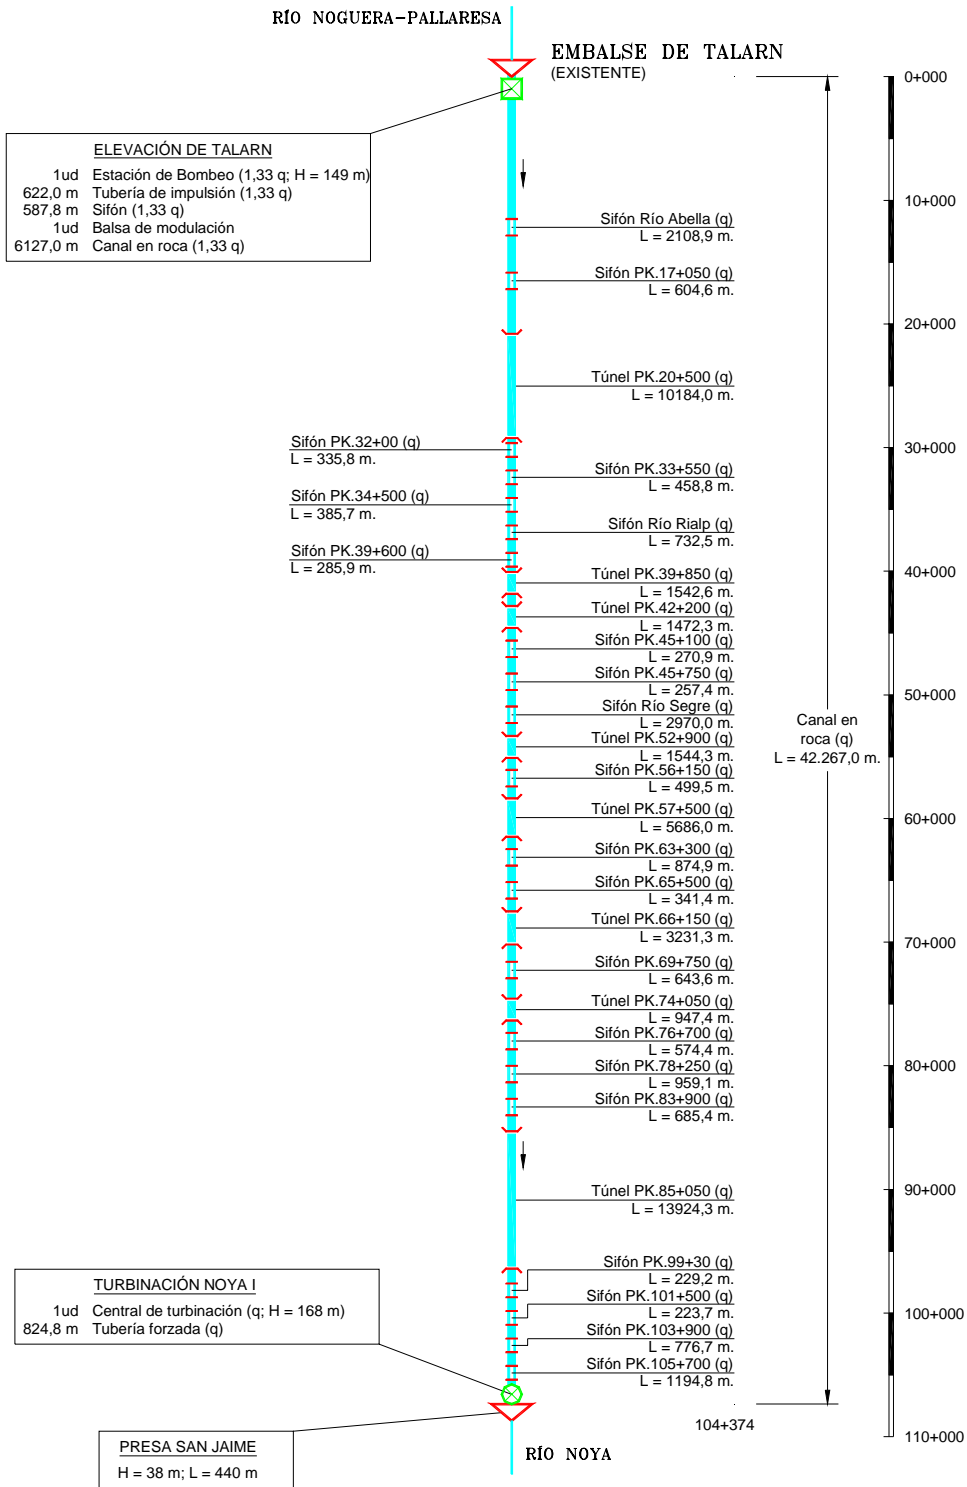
Conducción Segre – Barcelona. Esquema en planta
